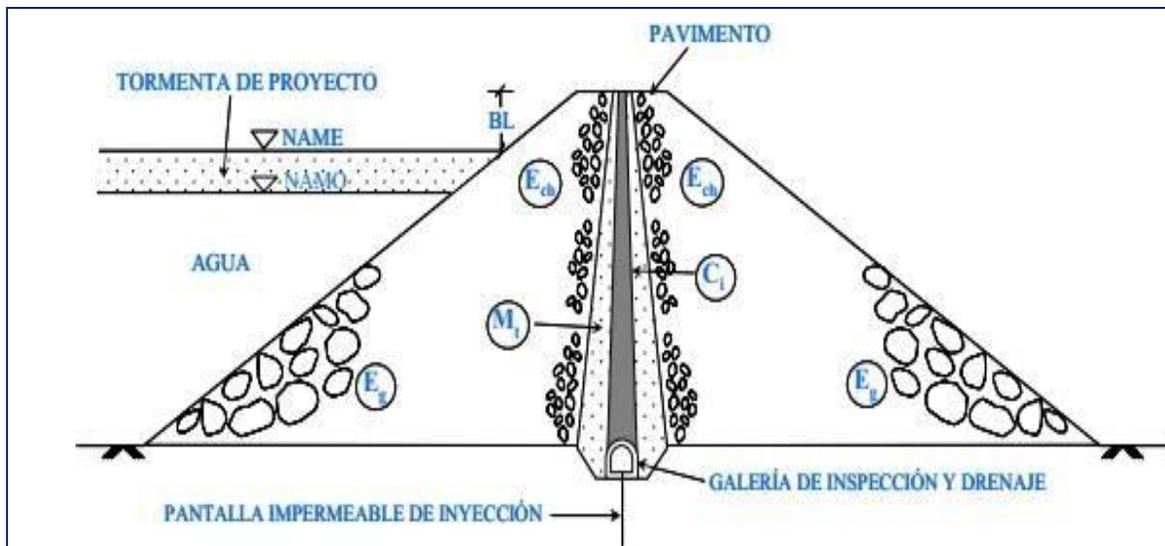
Corazón de concreto asfáltico impermeable en la cortina, según letra C₁
